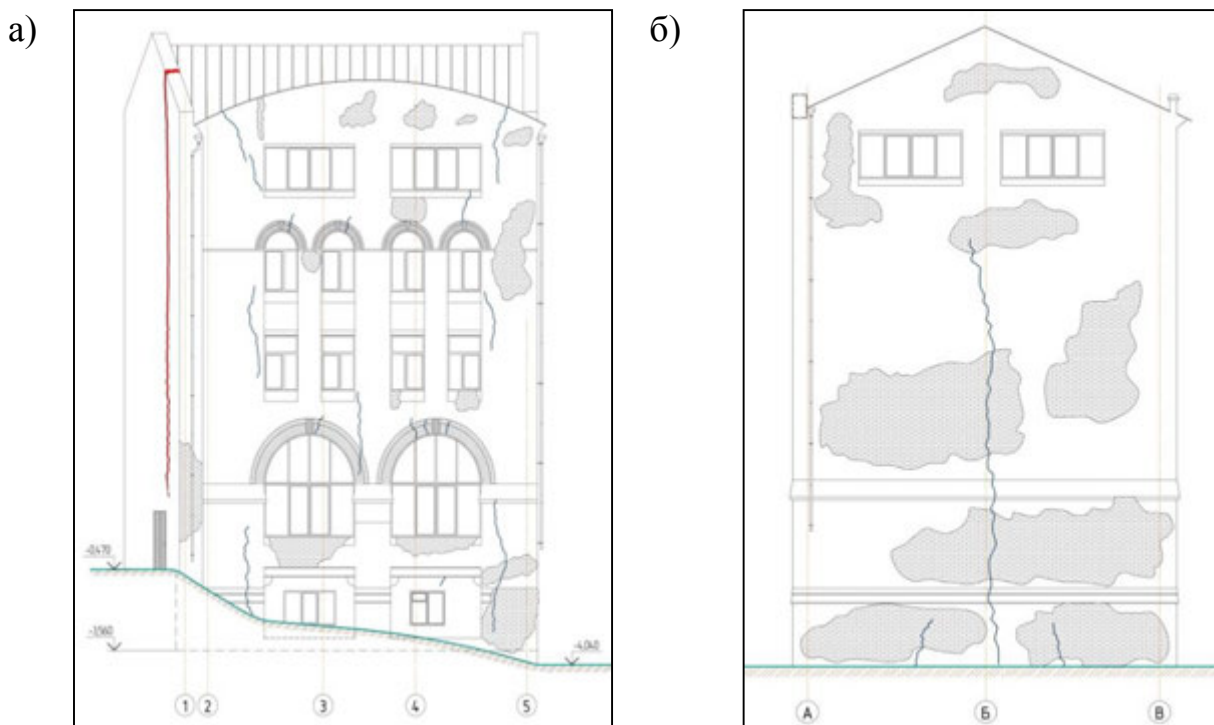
Схемы расположения дефектов и повреждений в наружных стенах а) в стене главного фасада; б) в торцовой стене. Вертикальные трещины с раскрытием до 12-15 мм, рассекают стены по всей высоте
